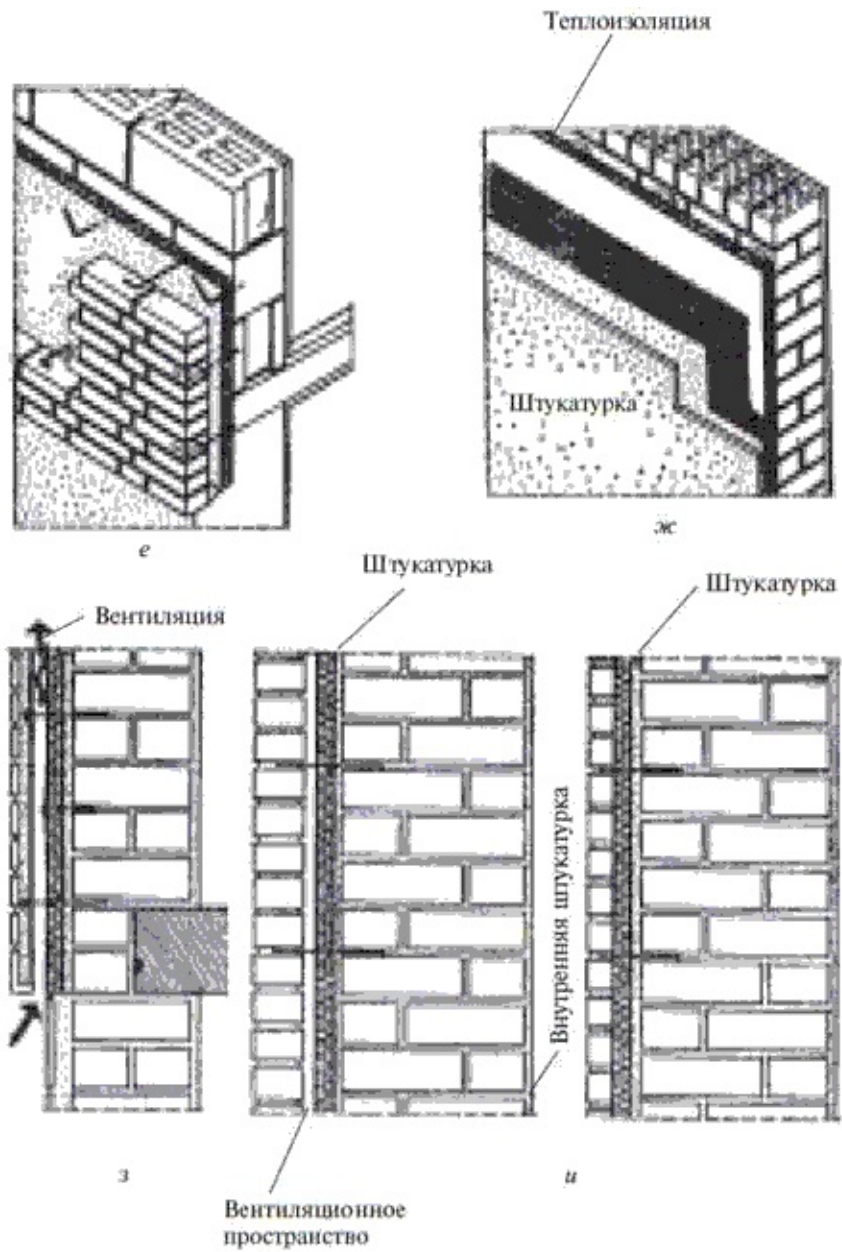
(продолжение). Устройство теплоизоляции на наружной стороне стены:
